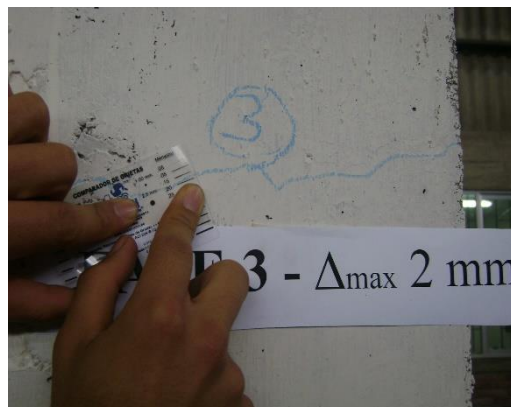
Fase 3: Más grietas en las columnas.
